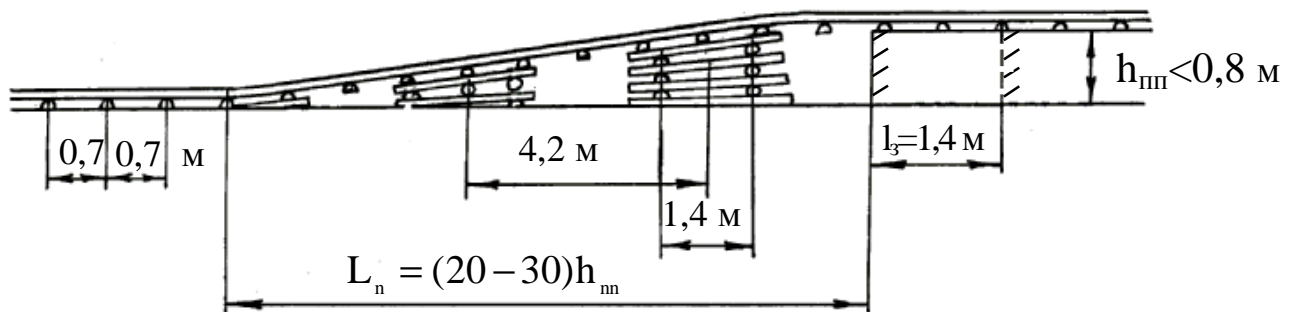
Схема удерживания рельсового пути при подрывке пород подошвы выработки
